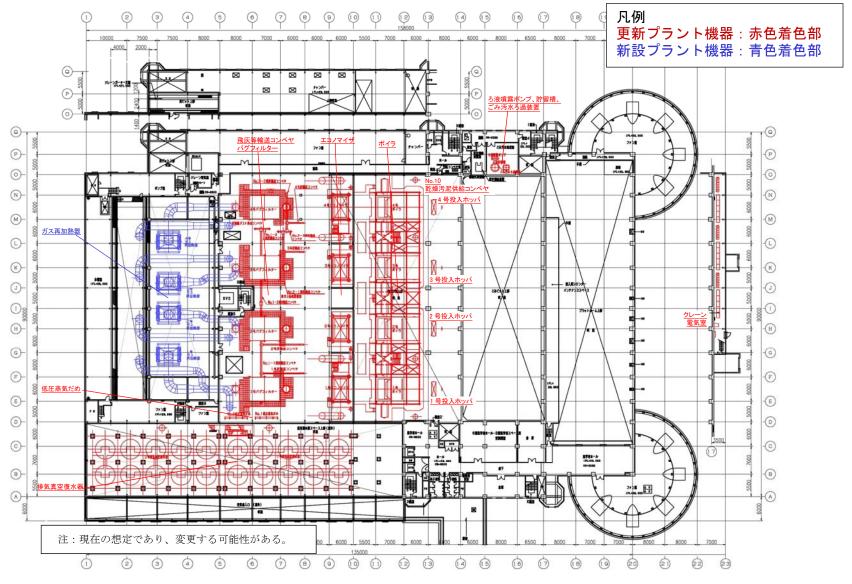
(6) 設備機器の更新箇所(6・7階平面図)
